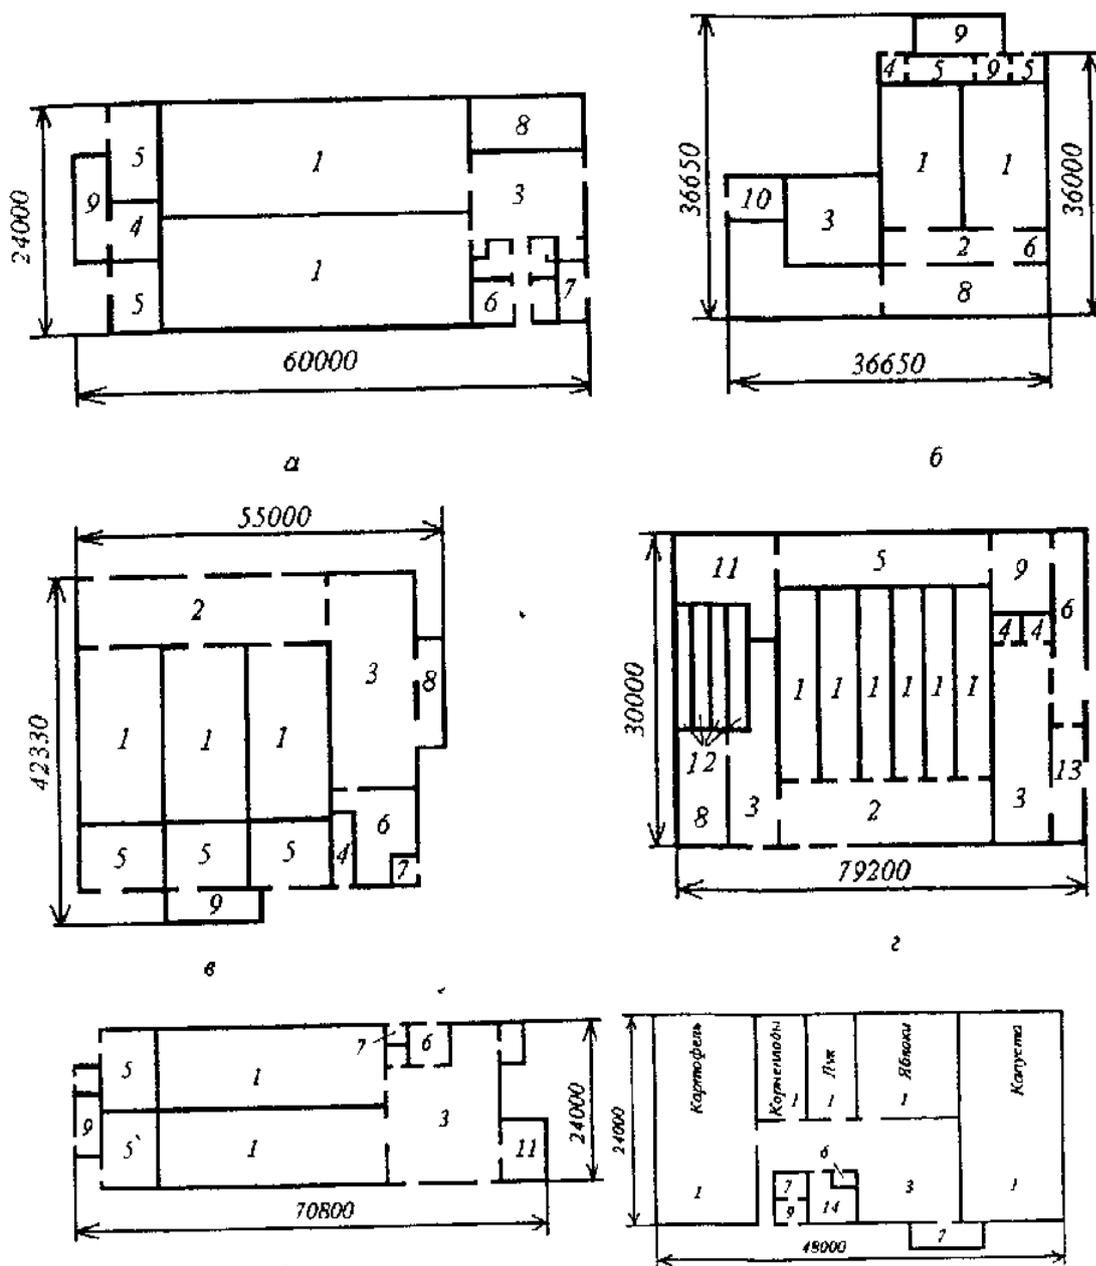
<sup>а</sup> — Планировочные решения хранилищ вместимостью 1000 т / а - хранилище для продовольственного картофеля ТП-813-2-70.92; б - хранилище для семенного картофеля ТП-813-2-63.91; в - хранилище для капусты ТП-813-2-67.91; г - хранилище для лука ТП-813-2-62.90; д - хранилище для моркови ТП-813-2-49.88; е - комбинированное хранилище ТП-813-2-25.86; 1 - помещение хранения; 2 - тамбур, грузовой коридор; 3 - цех товарной обработки; 4 — электрощитовая; 5 — вентиляционная камера; 6 - бытовые помещения; 7 — тепловой пункт; 8 — приемное отделение; 9 - машинное отделение; 10 — отделение протравливания; 11 - навес; 12 - закроем; 13 - экспедиция, 14-зарядная.
